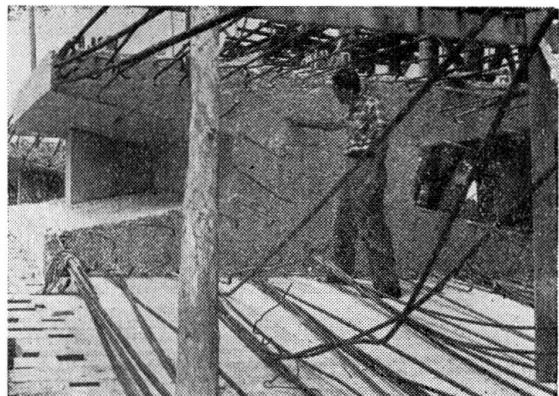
Pormenor da secção duma aduela do arco da ponte da Foz do Sousa
